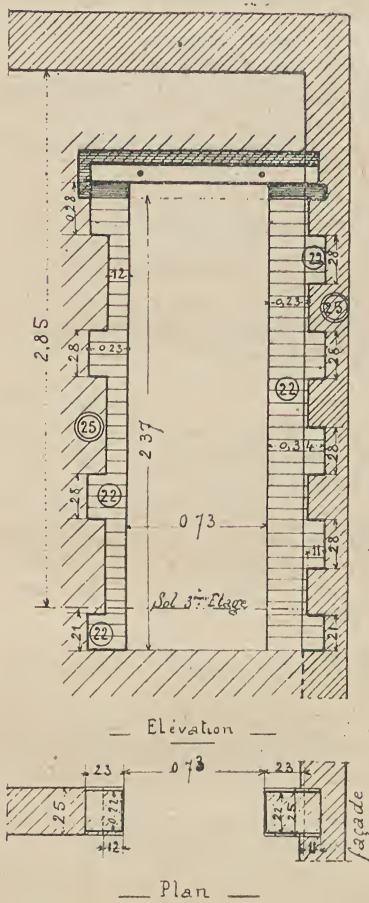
Elévation et plan des reprises par arrachement en brique.
